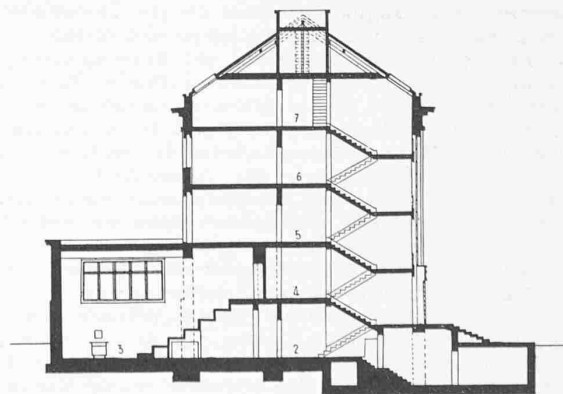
Schnitt 1:400. — 1 (rechts) Heizung und Kohlen, 2 Untergeschoss, 3 Hörsaal, 4 Erdgeschoss, 5/7 Obergeschosse
